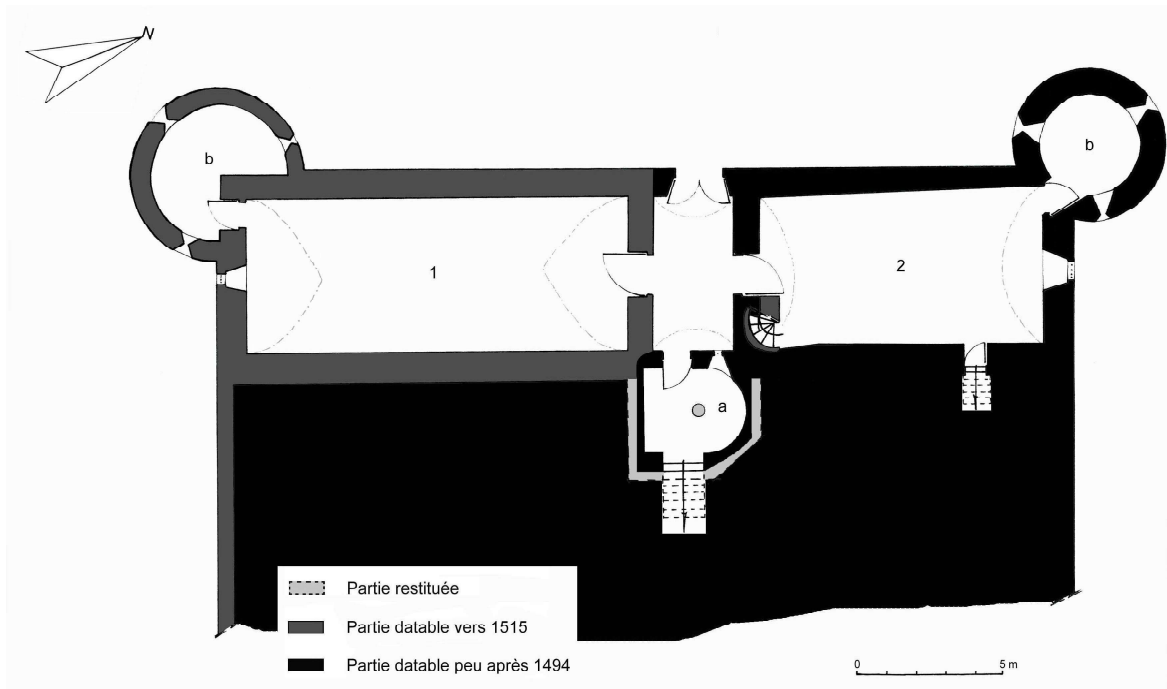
Houlbec. Plan restitué de l'étage de soubassement en 1603 (voir : Volume III, Document n° 21).
